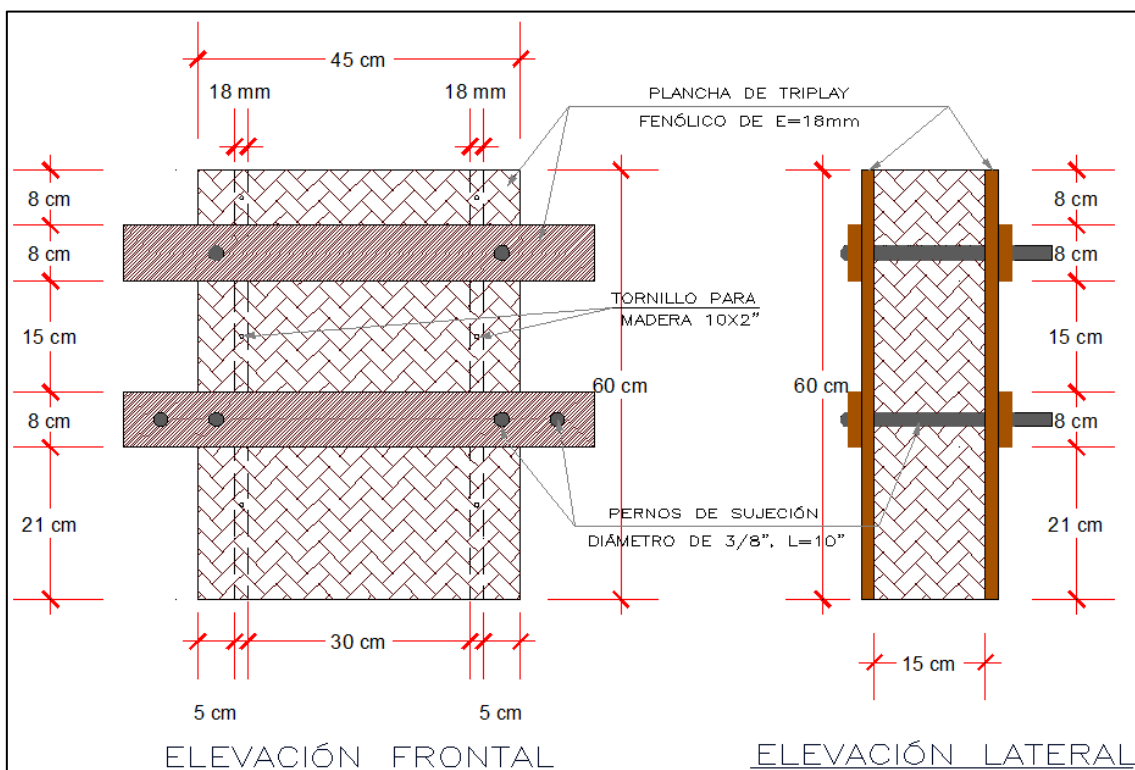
Elevación frontal y lateral del encofrado para la construcción de pilas.
